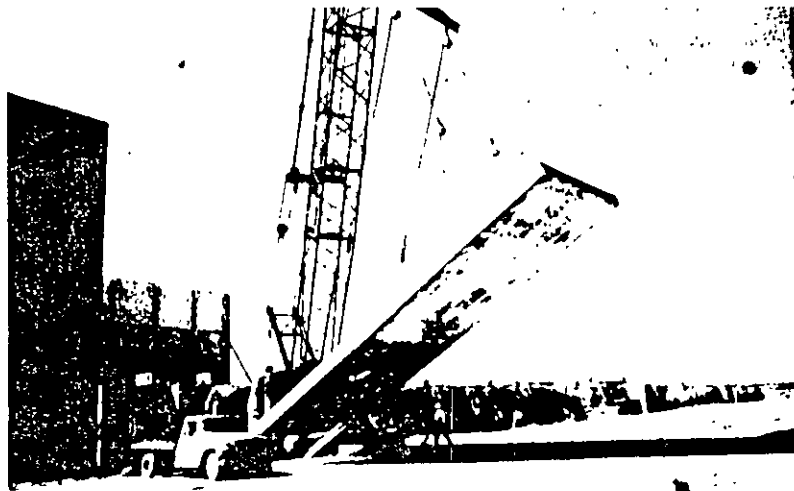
La distinción entre construcción prefabricada y construcción por volteo consiste en que en esta última los paneles siempre se vacían en la obra y son, por lo general, demasiado grandes para poder ser transportados desde una planta de prefabricación. Aquí se ve un panel de 45 ton en el momento del montaje.
